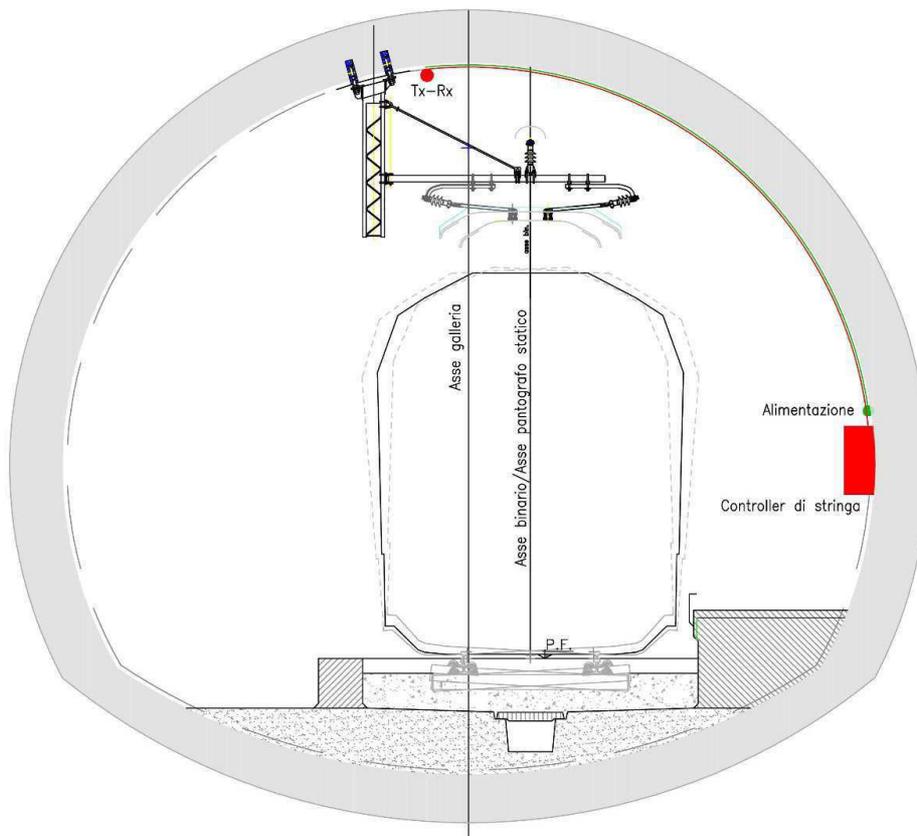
Disposizione dei rilevatori IR nella sezione a doppio binario (modificato da [1.3])
